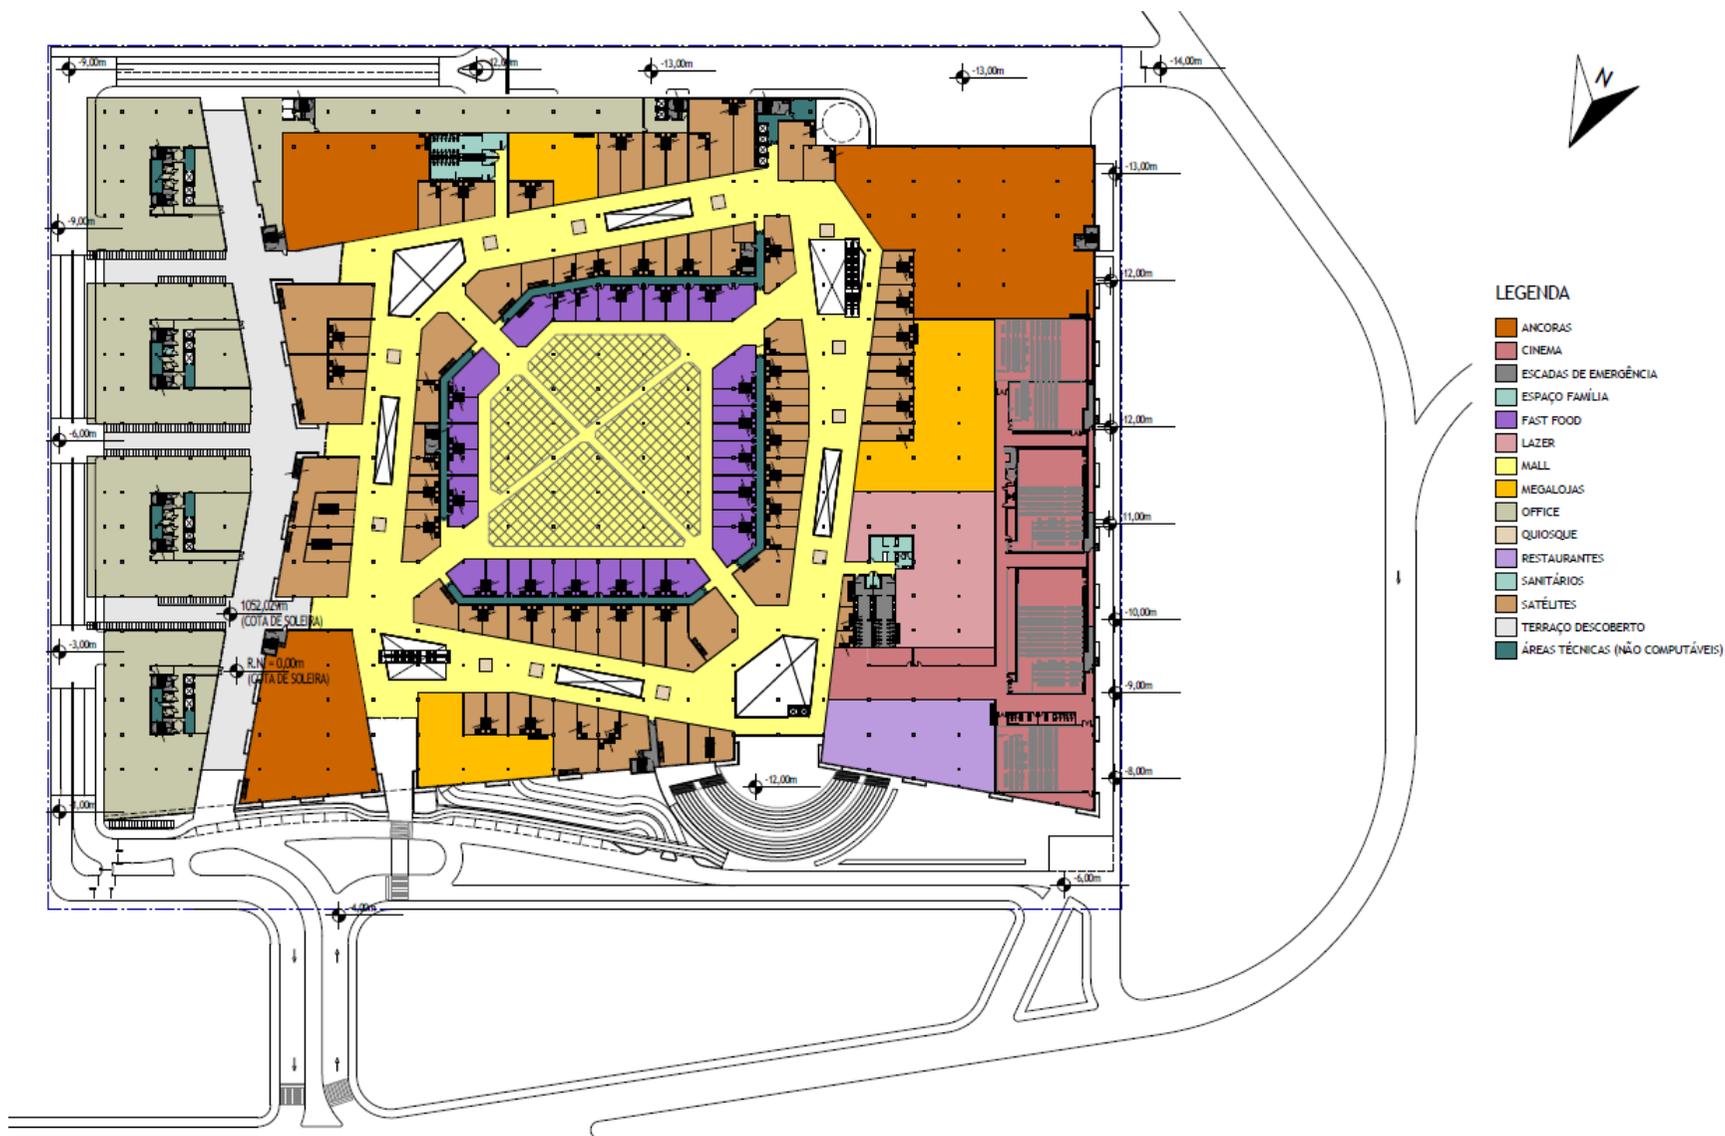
Planta baixa Térreo (L2), Nível 0,00m (R.N. 1052,029m)
